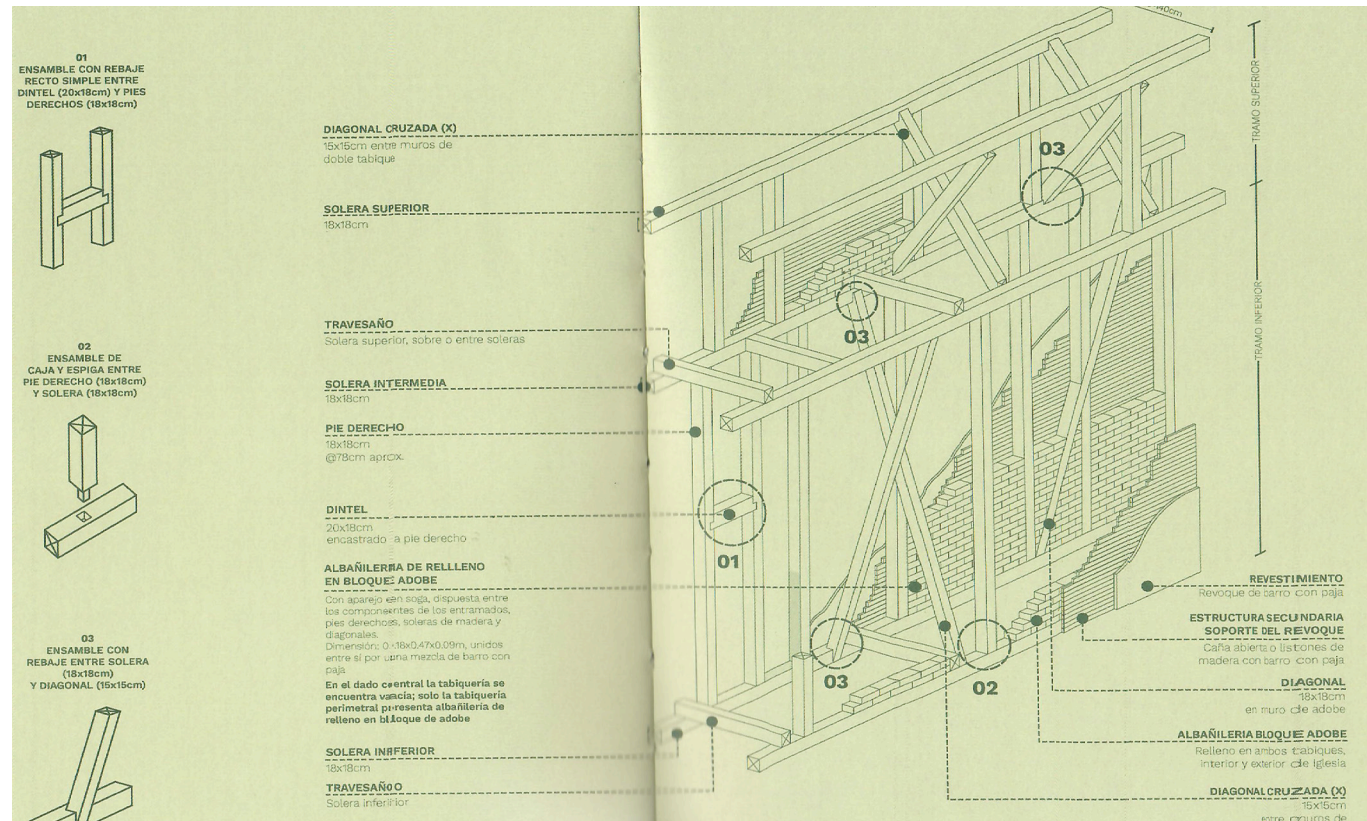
Esquema constructivo de iglesias con doble tabiquería en el Norte Chico. Fuente: Muñoz (2023).
